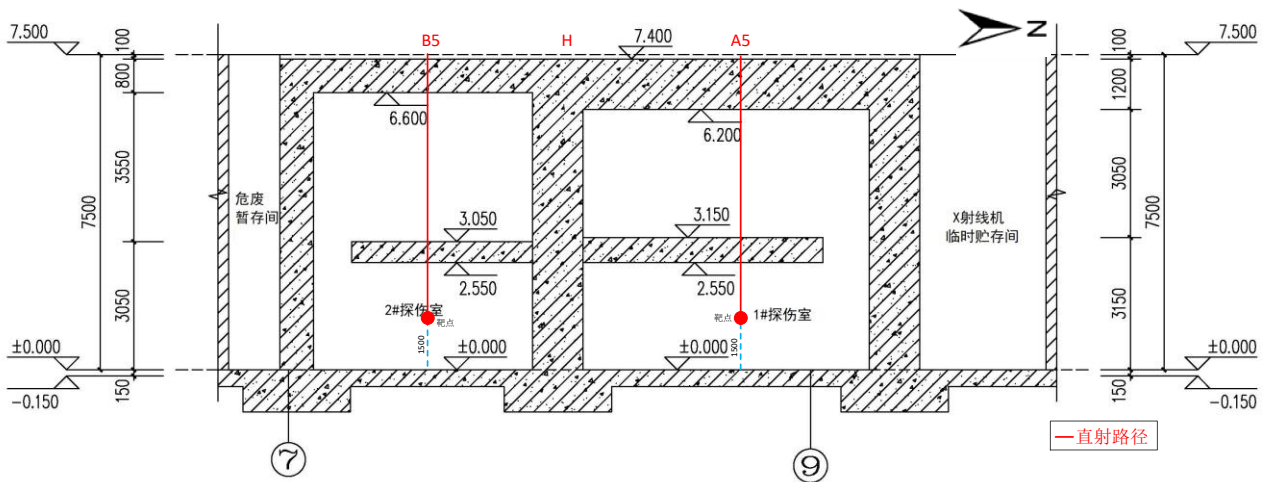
探伤工作场所平面布局及预测点位示意图（单位：mm）
